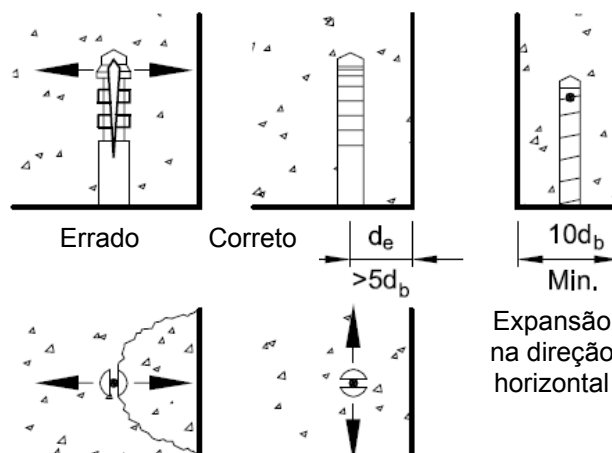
Ancoragens de expansão instalados pós concretagem (PCI, 2006)
